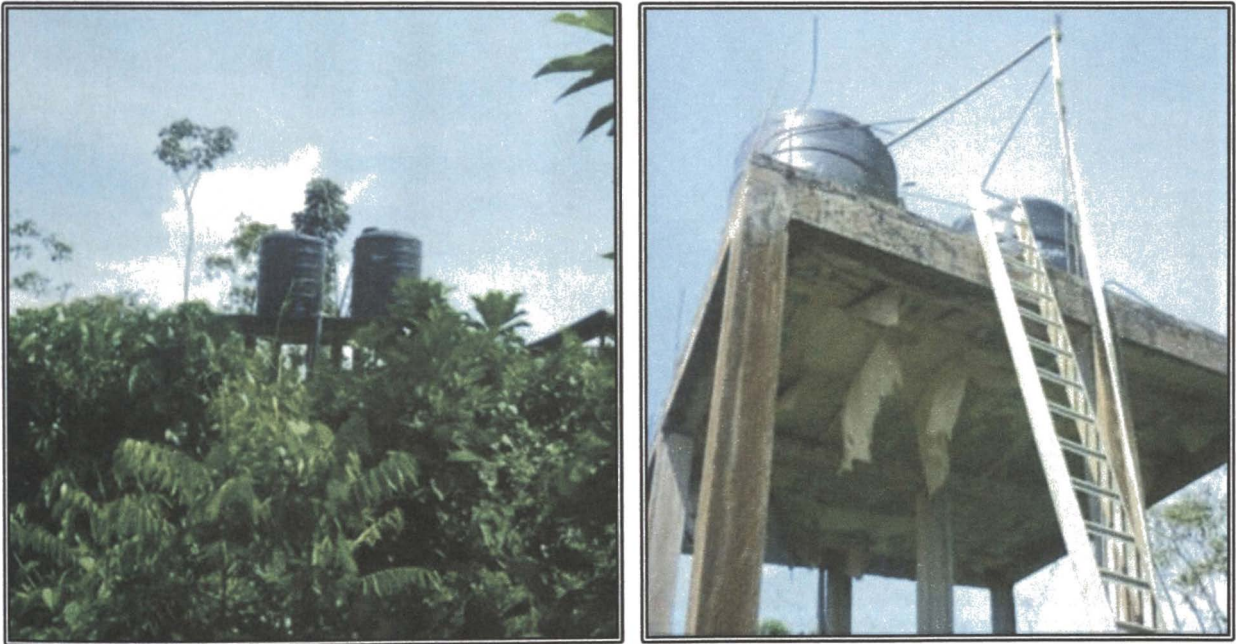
RESERVORIO ELEVADO EXISTENTE (SISTEMA SELVA VERDE).
